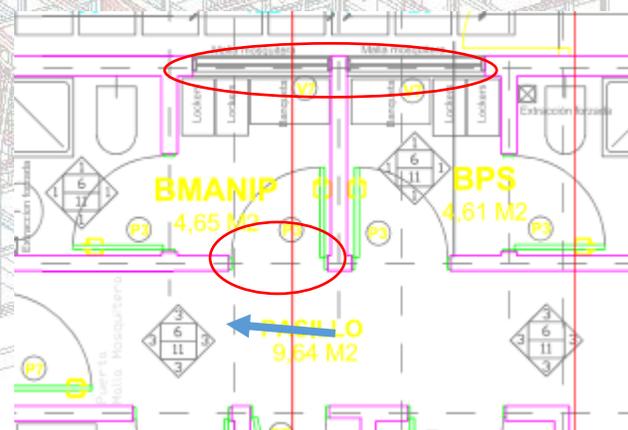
Planta primera al final de los módulos 9 y 10. Fuente Obra Sala Cuna Bosquemar, Constructora Molina Asenjo. Mirasol Puerto Montt
